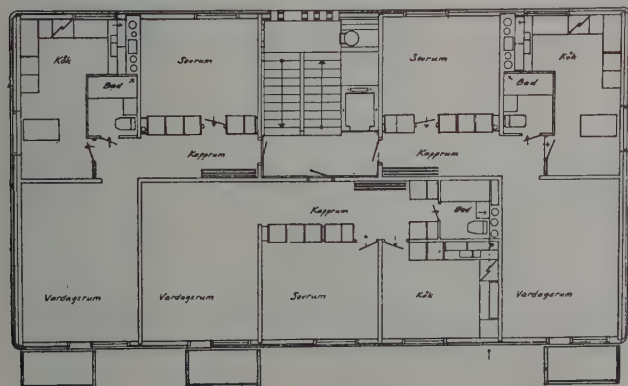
Siebengeschossiges Wohnhaus in Växjö, Architekt Erskine. Variabler Grundriß (Dreispanner zwei Zimmer und Küche, Bad; Dreispanner 1 + 2 + 3 Zimmer; Zweispanner 2 + 3 Zimmer), gegossene Betonwände, Querwandbauweise, Ortbetondecken. Fassadenplatten 4,00/2,90 m groß, als Mehrschichtwand ausgebildet (Betonplatte, Dämmplatten, Papplage mit Aluminiumfolie, Gipsplatte innen). Waagerechte Fugendichtung = 2 cm hohe Korkstreifen. Vorgefertigte Balkone als Betonkästen an Auslegern mit Drahtseilen frei vor die Fassade gehängt
